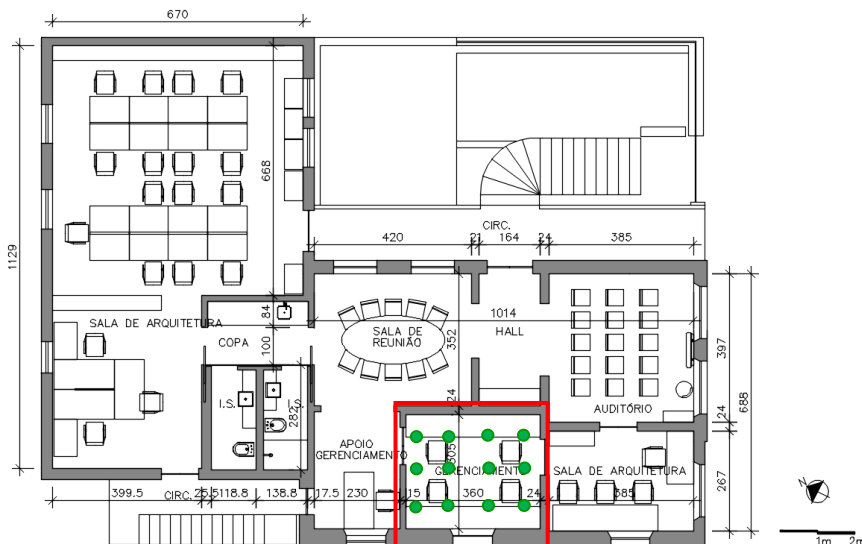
Planta do segundo pavimento da casa. Indicação da sala em estudo e dos pontos escolhidos para realizar as medições.
